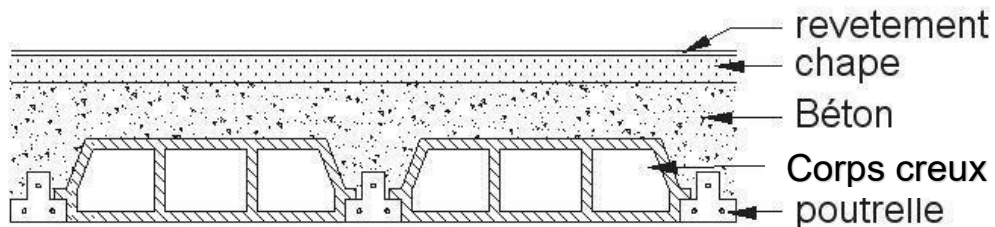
Coupe transversale d'un plancher en corps creux.
